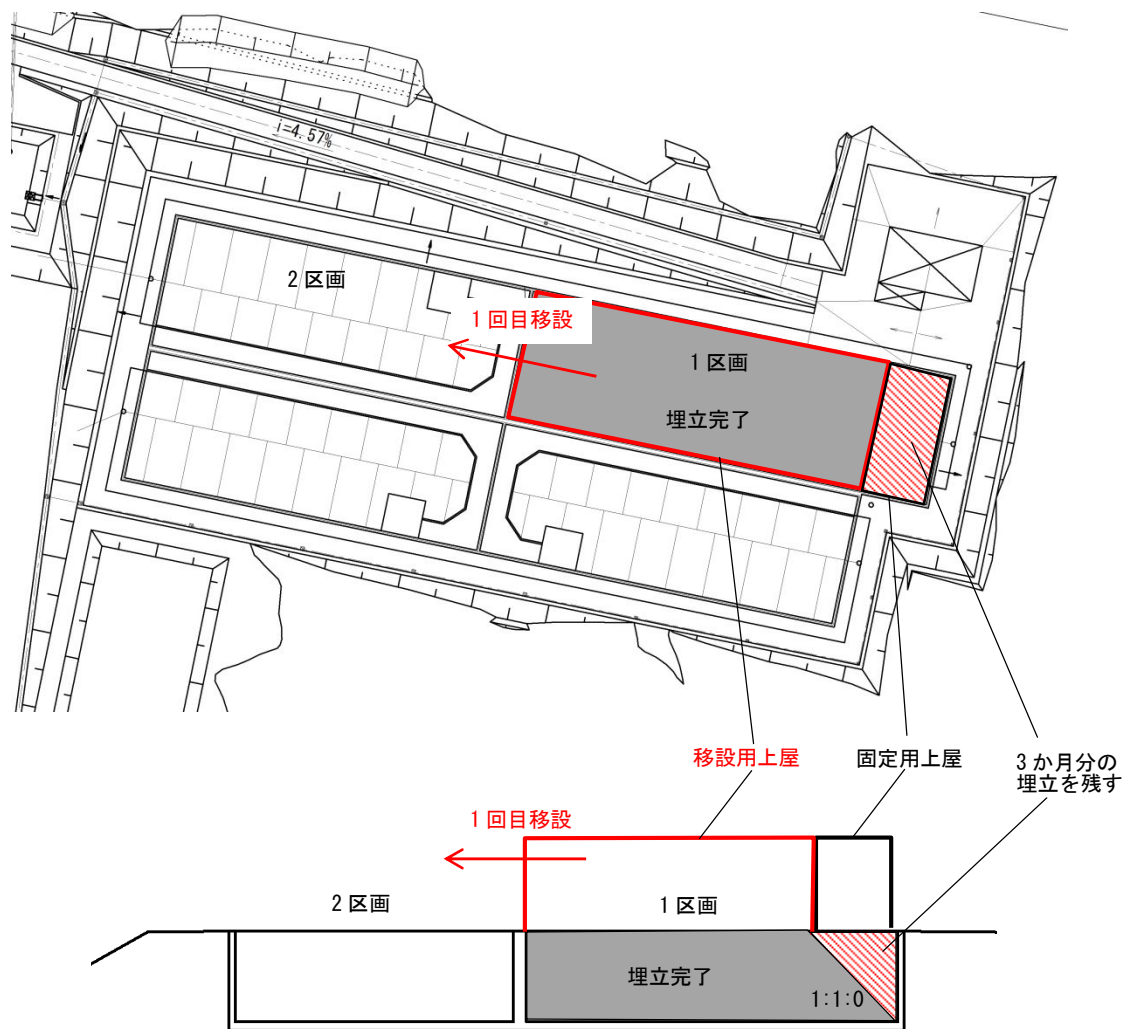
埋立地平面図・標準断面図 (1 回目・上屋移設時)
